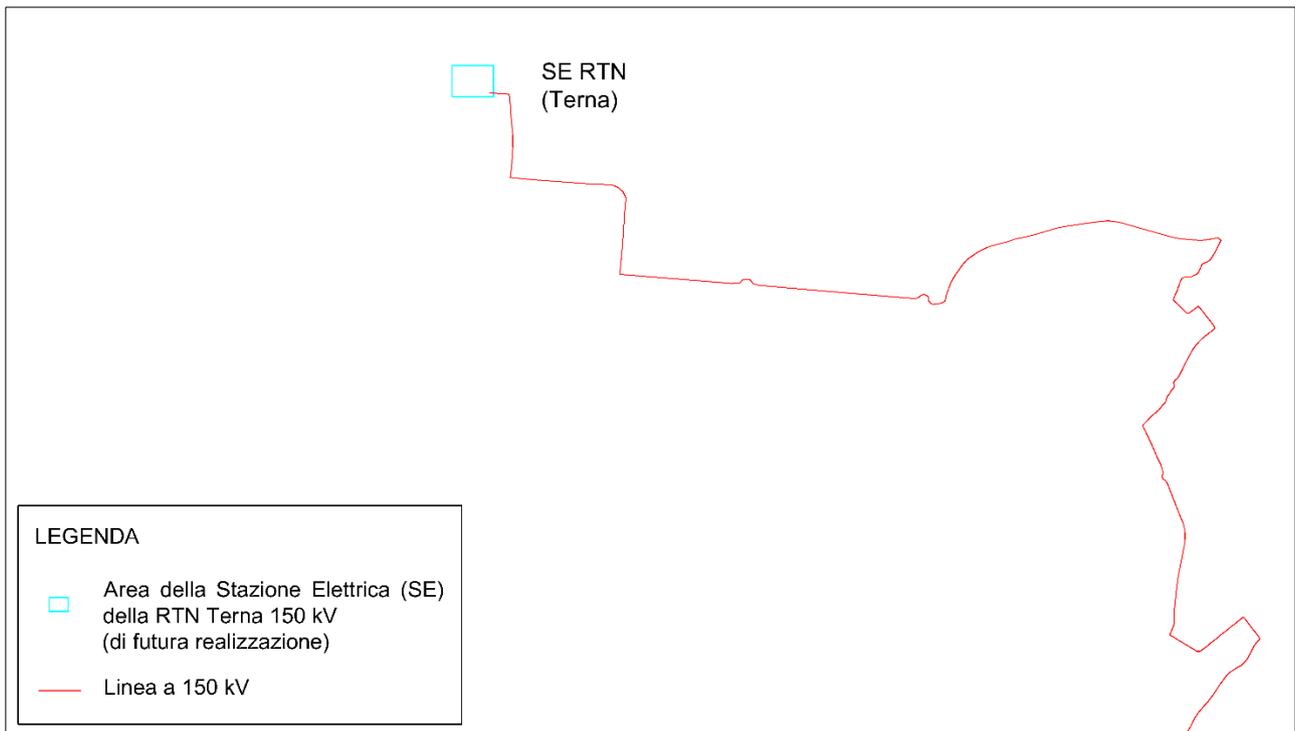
Dettaglio 3 planimetria generale di distribuzione linea a 150 kV
